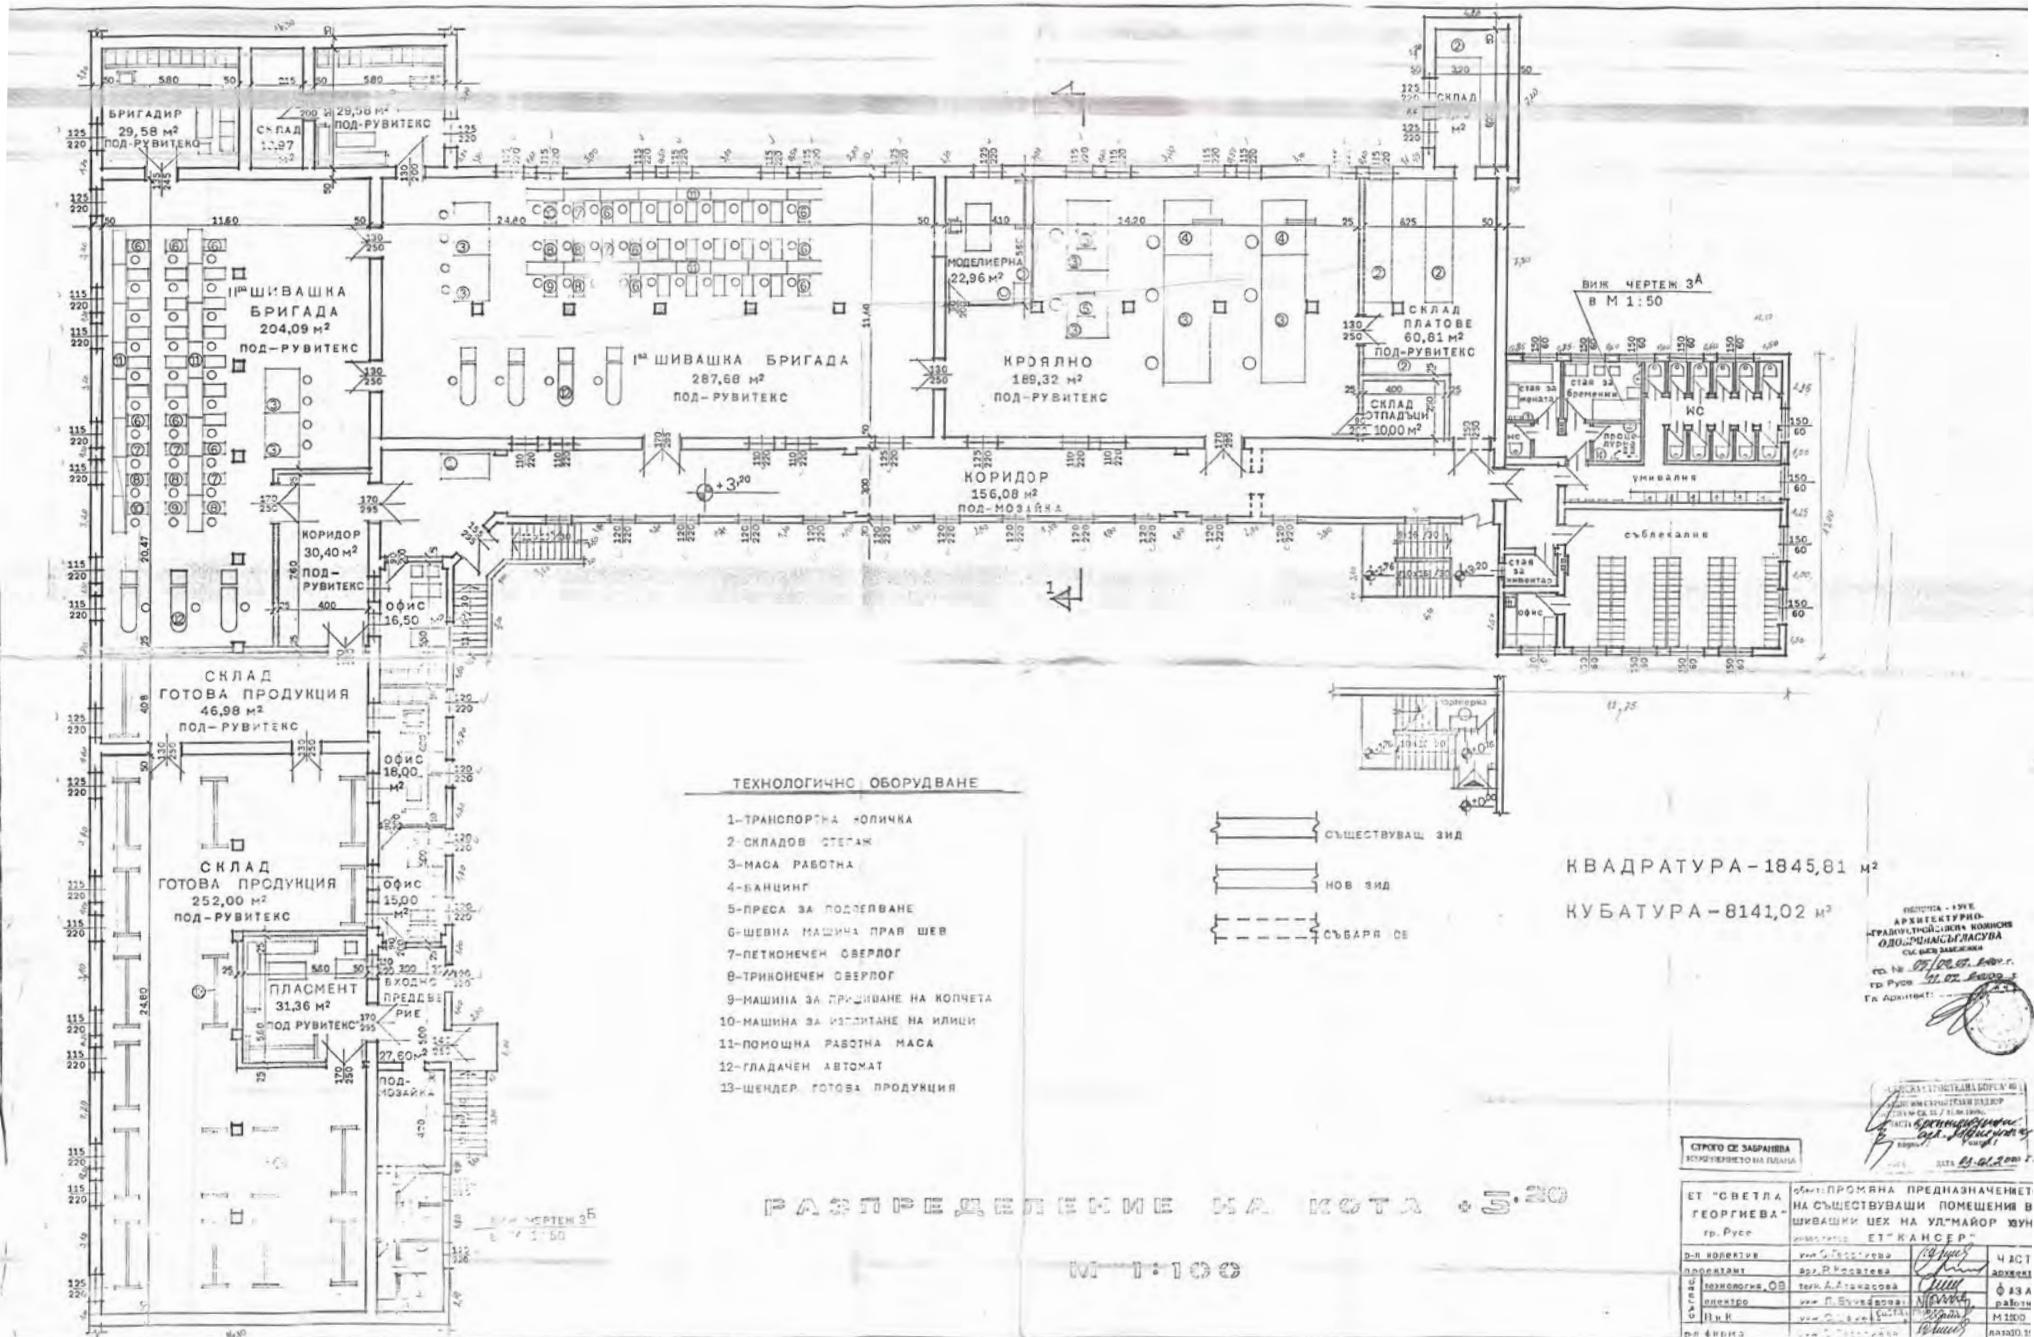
Grundriss 1.Obergeschoss Kaserne, Pläne aus dem Kataster in Russe
